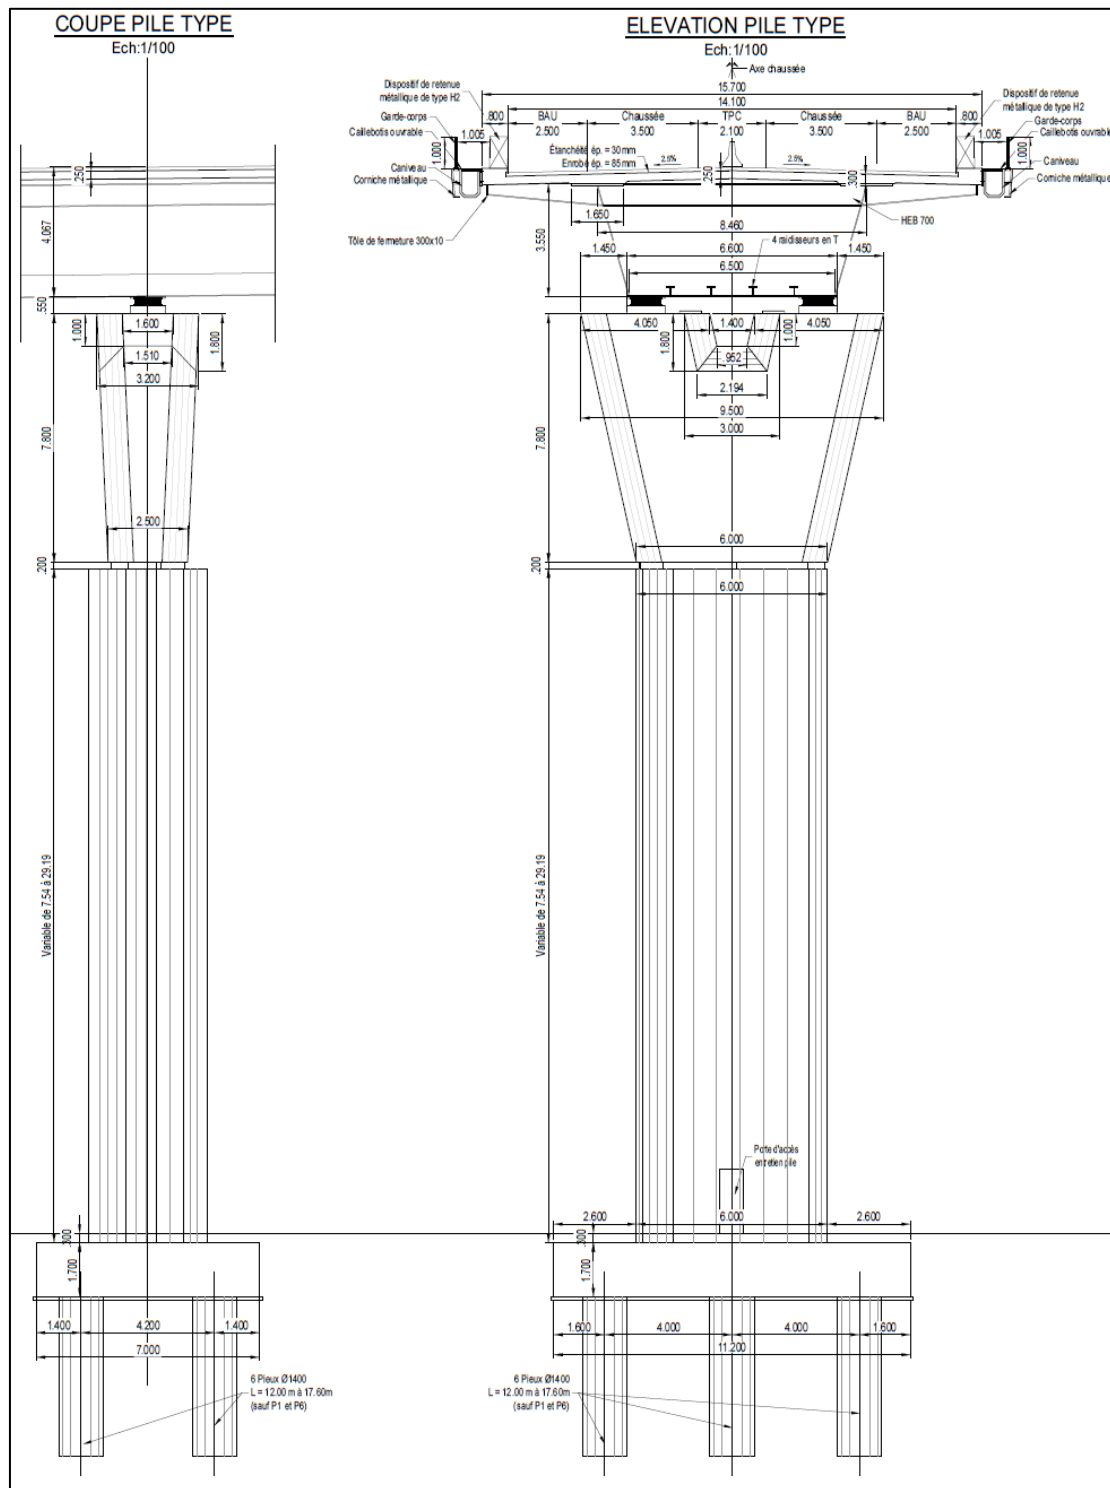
Élévation et coupe type sur une pile du viaduc de Vienne
